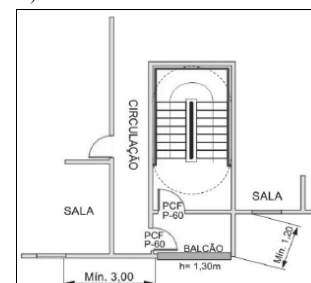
Escada enclausurada do tipo PF ventilada por balcão
